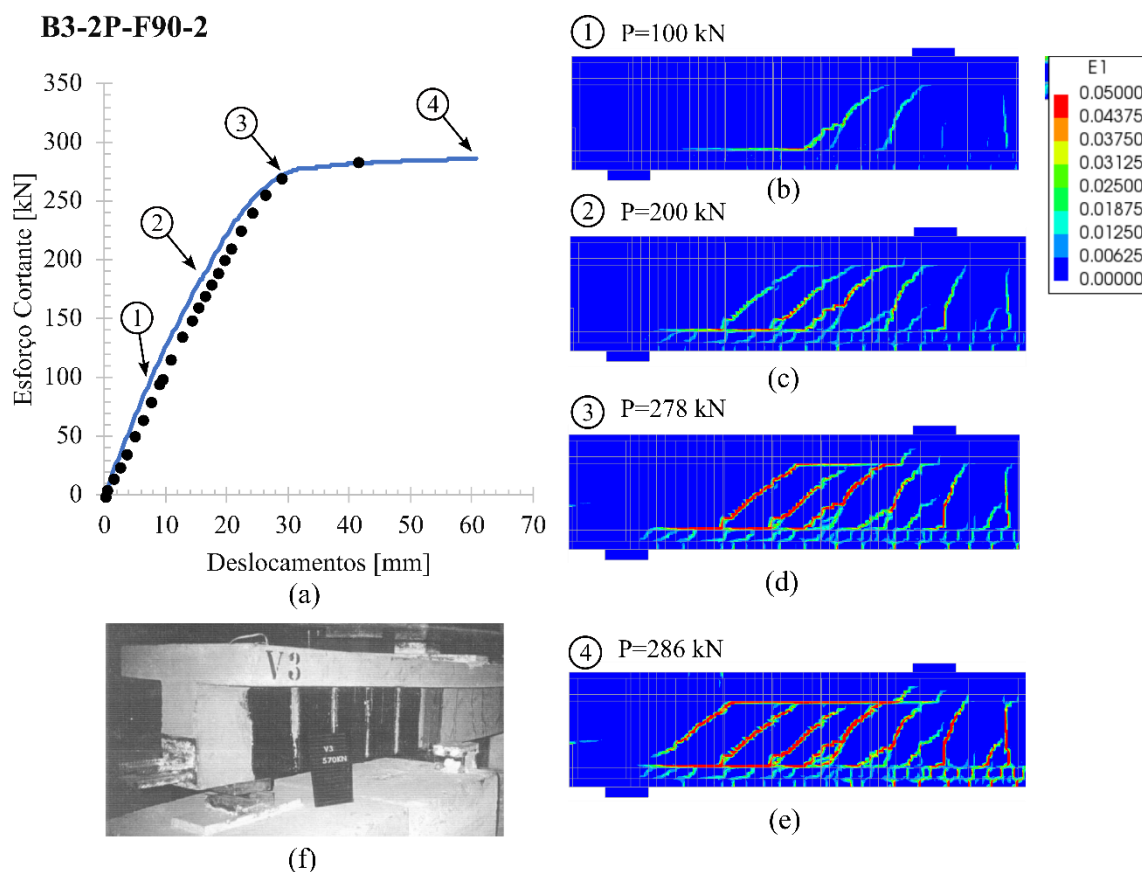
Esforço cortante e deslocamento no meio do vão obtidos numericamente, e padrão de fissuração para a viga B3-2P-F90-2.
